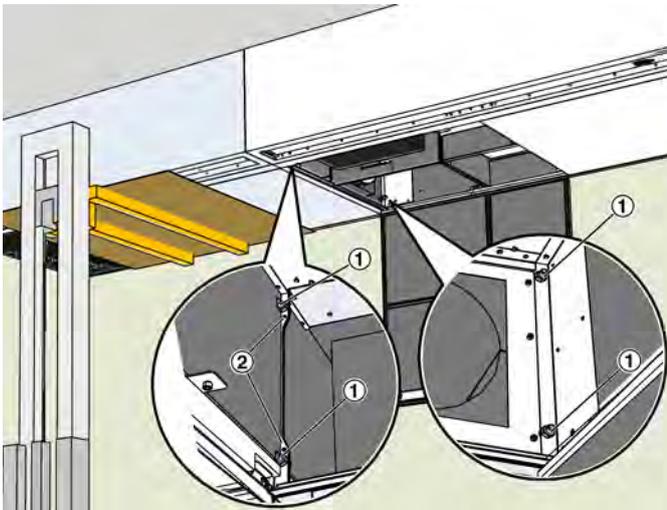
Bauteil 2 neben Bauteil 1 positionieren
